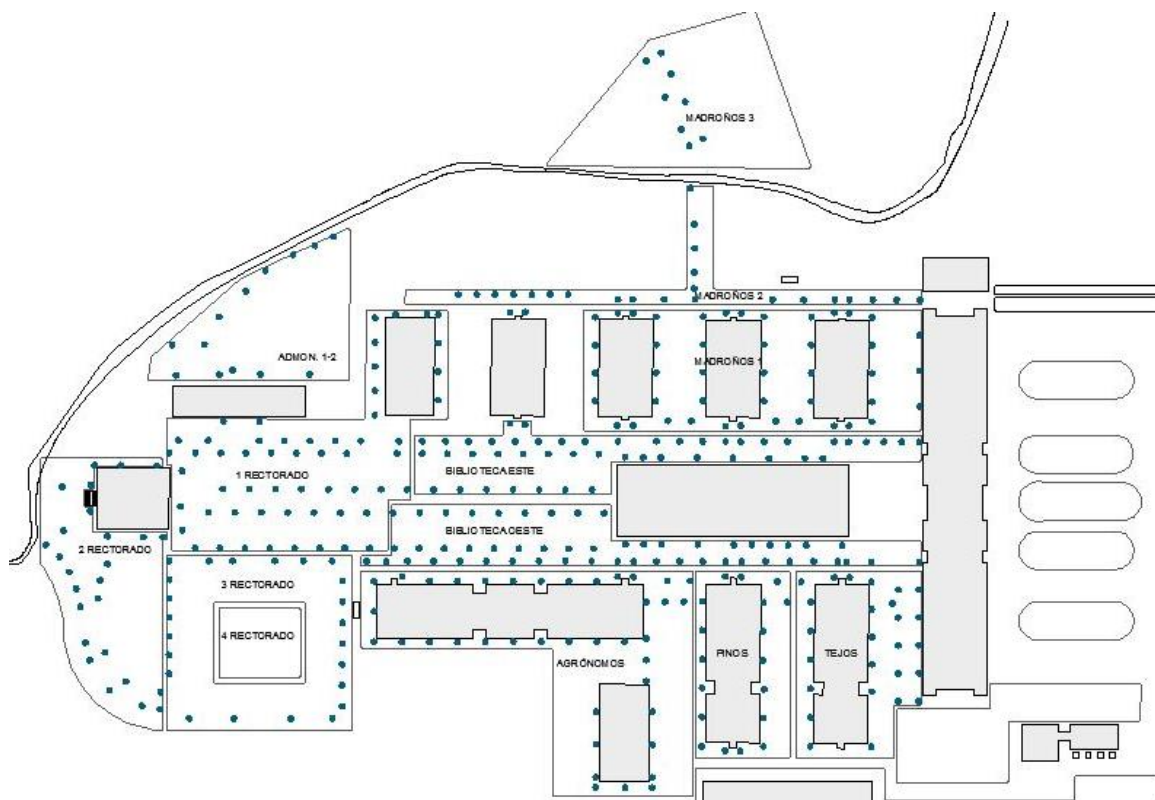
Se muestran las luminarias utilizadas en esta propuesta. El plano de planta de esta propuesta se encuentra en el anexo 4, plano 02.
